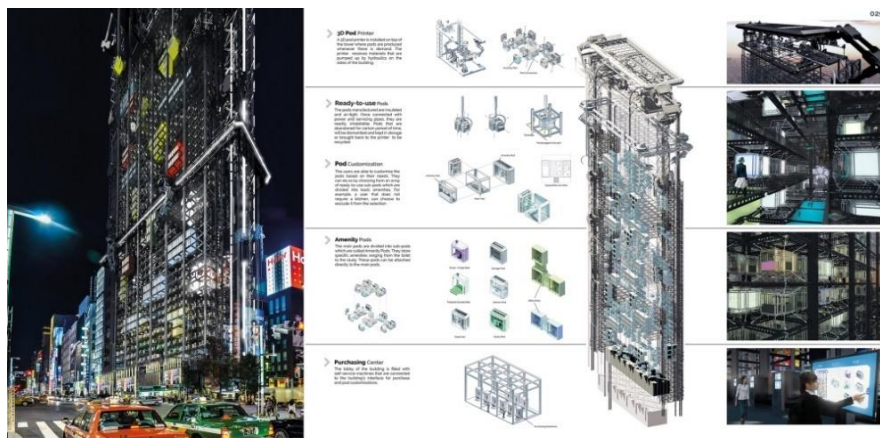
Pod Vending Machine Skyscraper [3]
